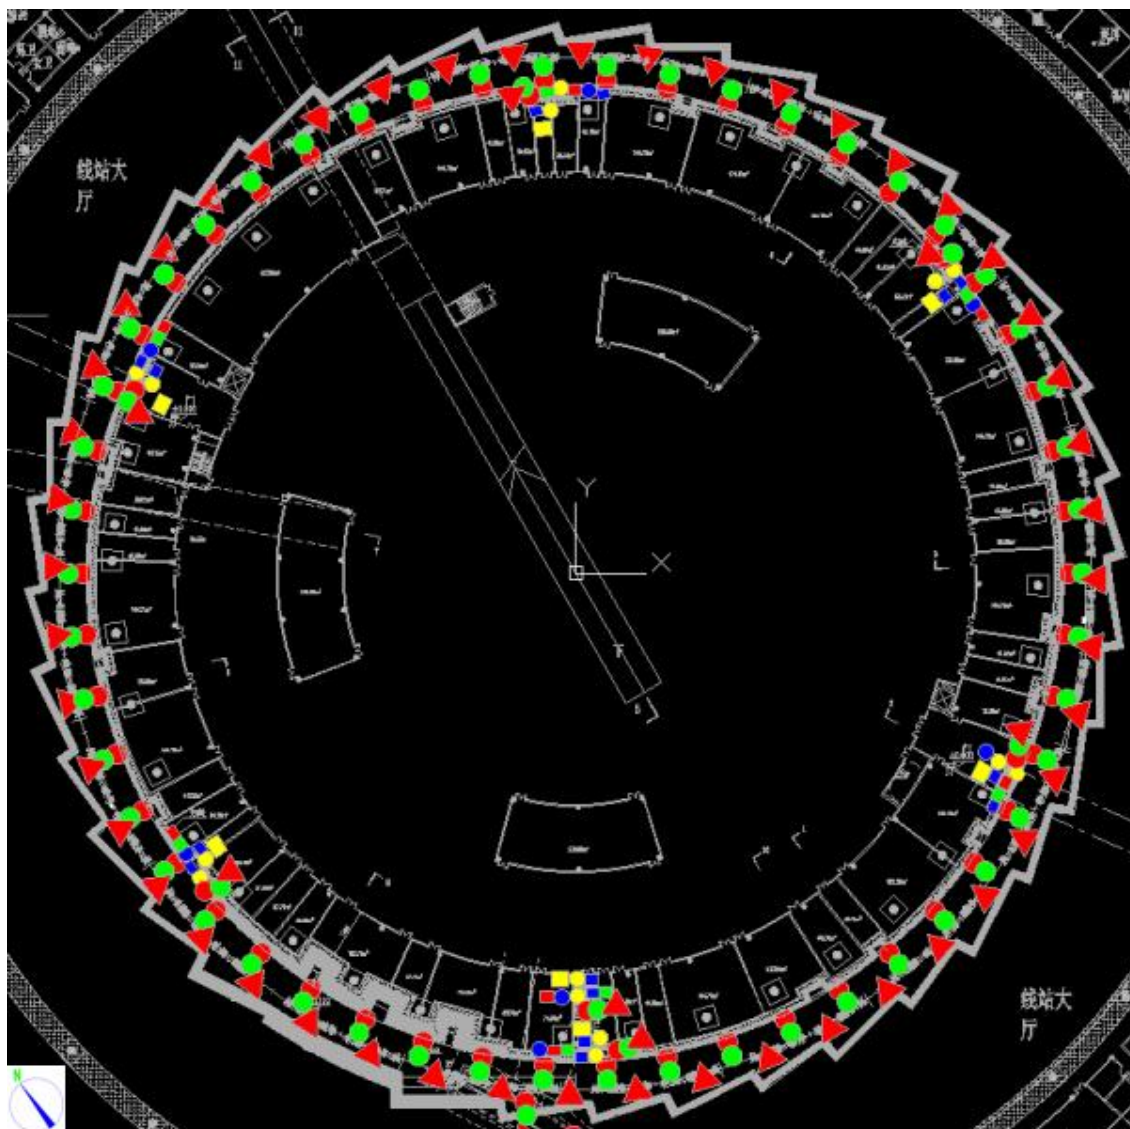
HALF 储存环人身安全联锁组件布置示意图
